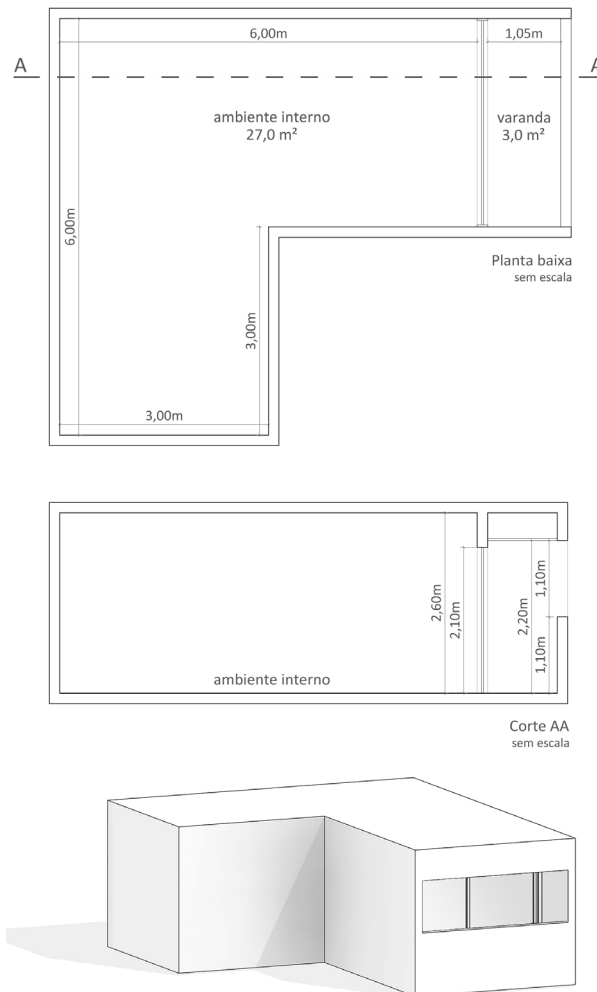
Planta baixa e corte AA' do modelo base.
